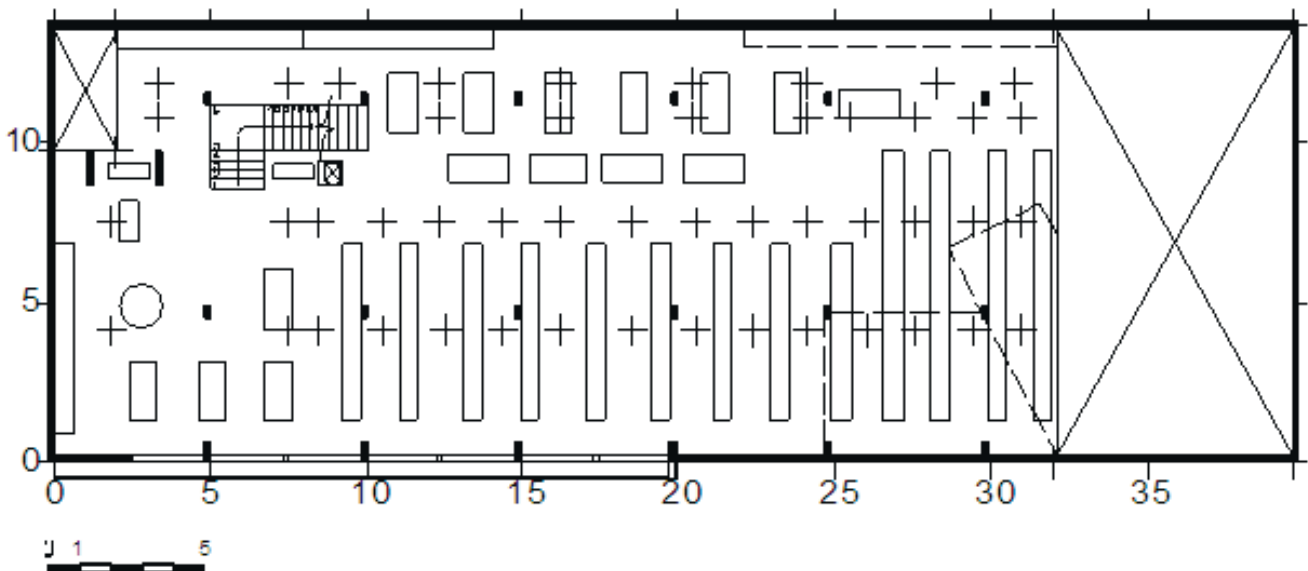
Layout da planta-baixa demarcando os pontos levantados pelo luxímetro.
